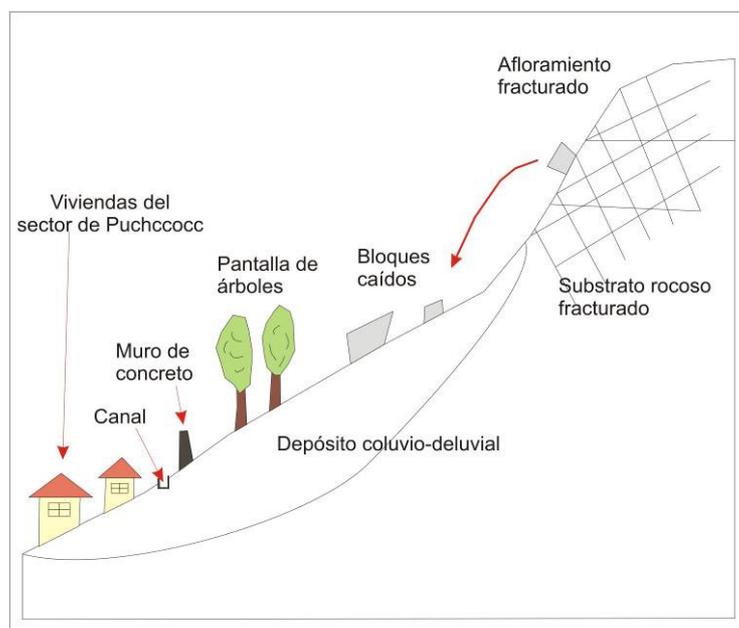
Zona de caída de rocas, donde la zona de arranque no es tan alta, se construye muro de concreto y pantalla de protección con árboles.
